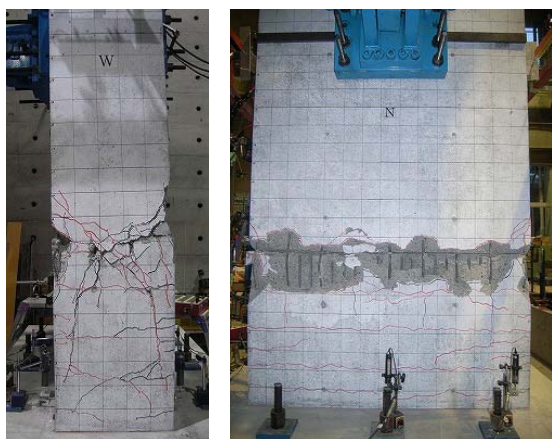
No. 1 供試体の損傷状況 (7 δ 時)
